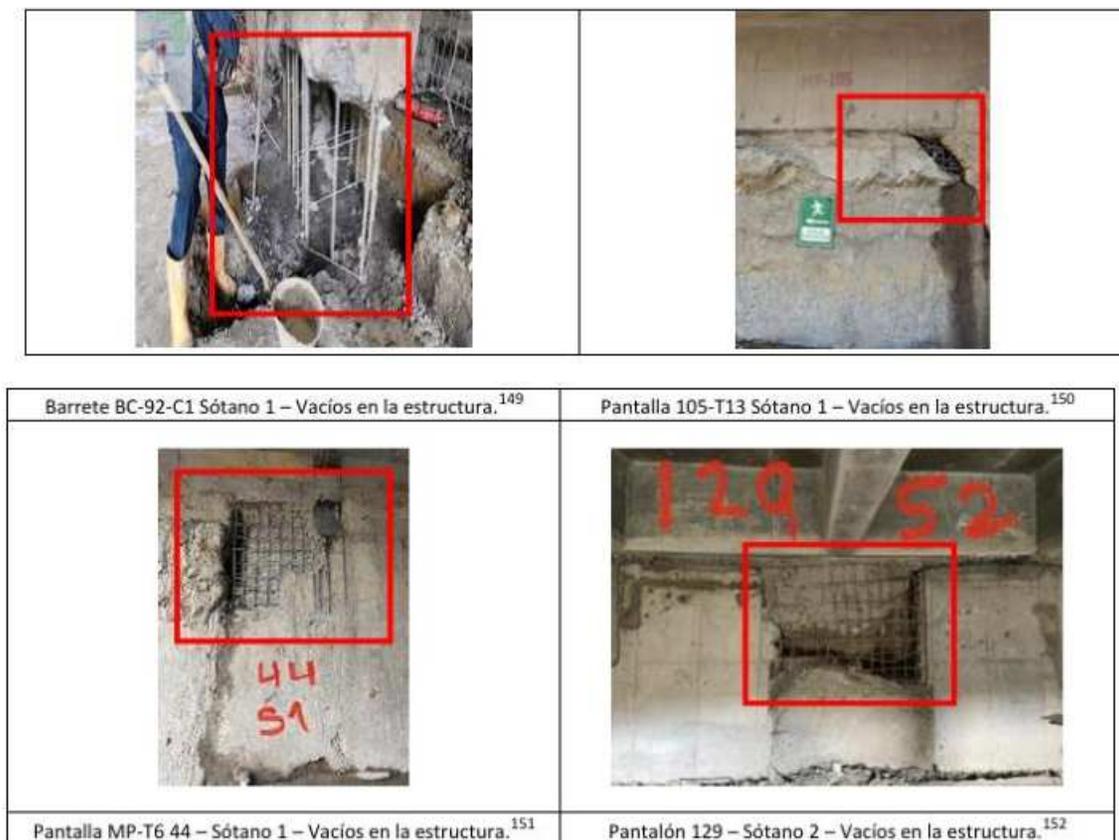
Elementos de Cimentación del Proyecto con Defectos de Calidad - Vacíos en la Estructura.
